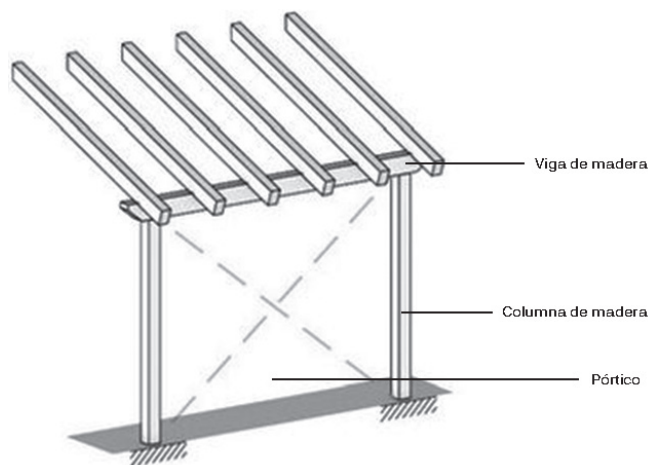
Detalle de los pórticos de una estructura de madera.
